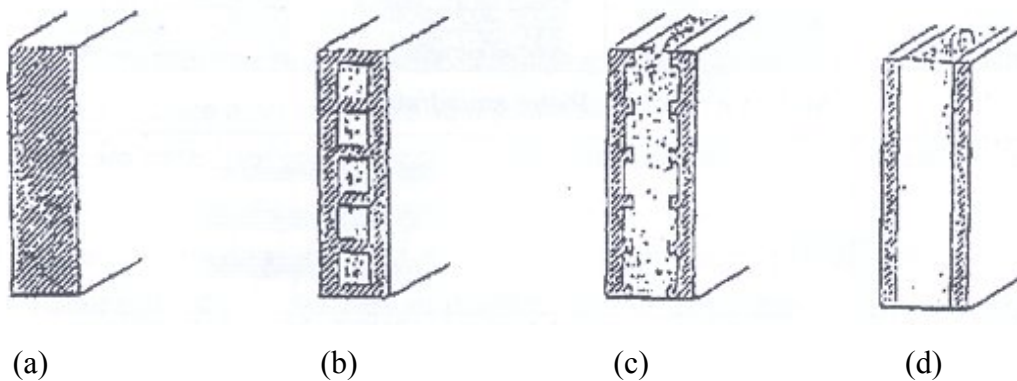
Ligação transversal entre paramentos [Valluzzi, 2000]: (a) conglomerado monolítico; (b) ligação reticulada; (c) ligação por sobreposição; (d) ligação plana.
